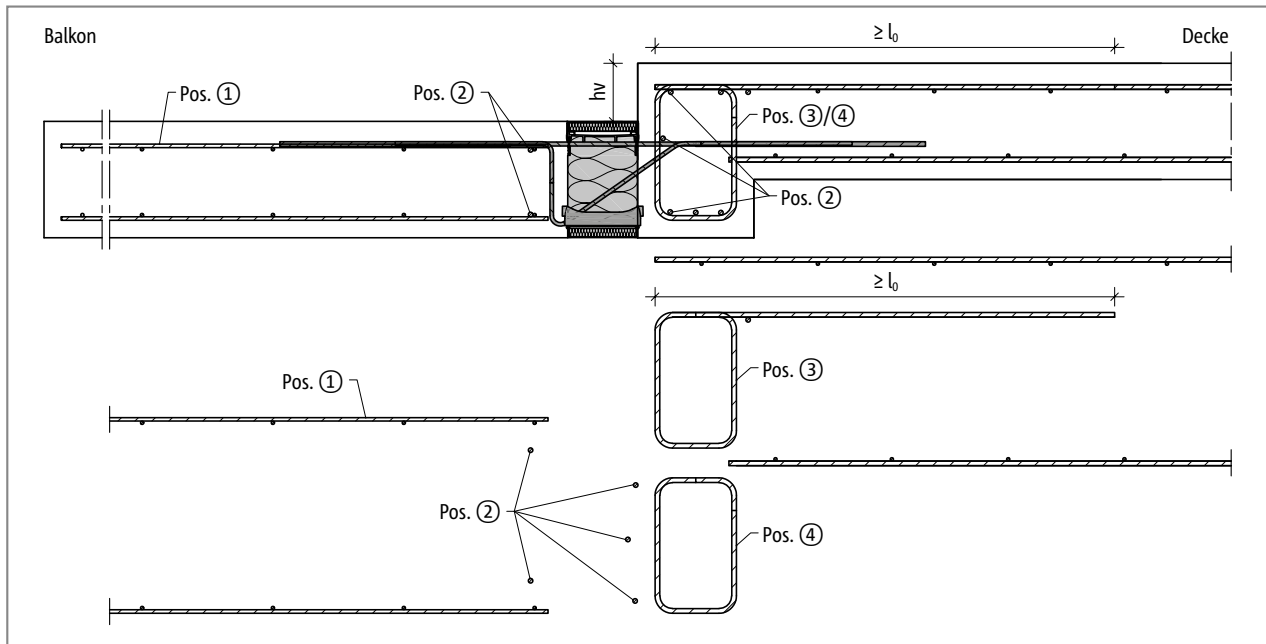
Schöck Isokorb® XT Typ K: Bauseitige Bewehrung für kleinen Höhenversatz
